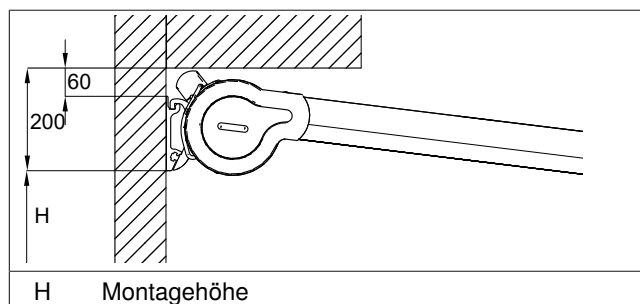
notwendiger Montageaum nach oben bei starrem Verstärkungsprofil (alle Maßangaben in mm)
